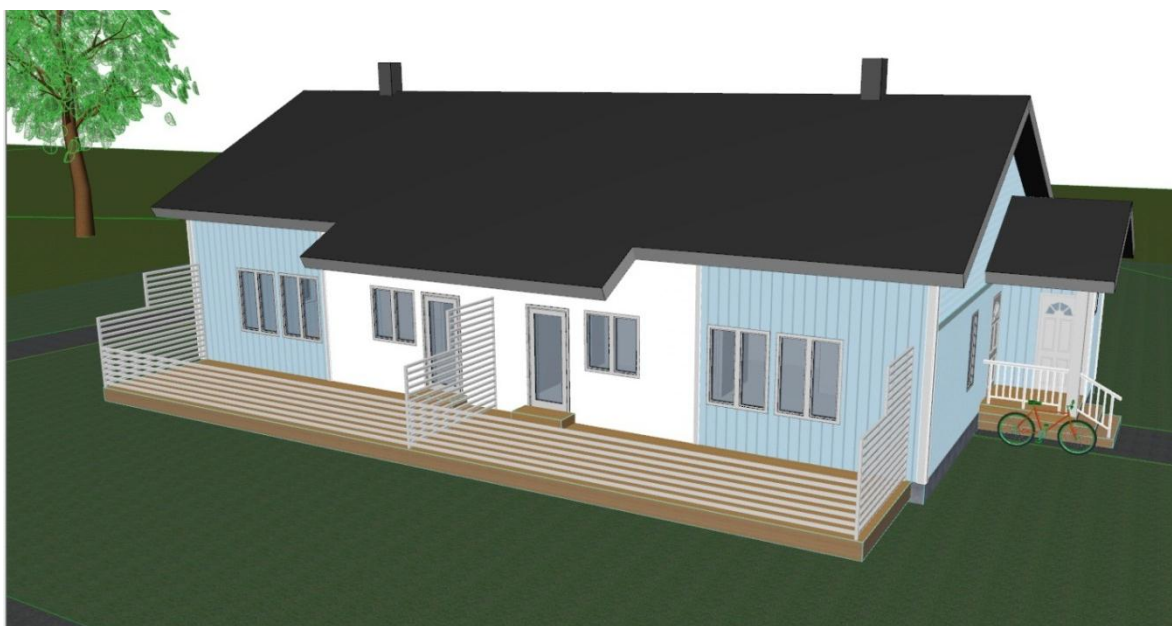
Situationsplan och planlösningar överfördes från AutoCAD till ArchiCAD för att användas som underlag för modelleringen.
